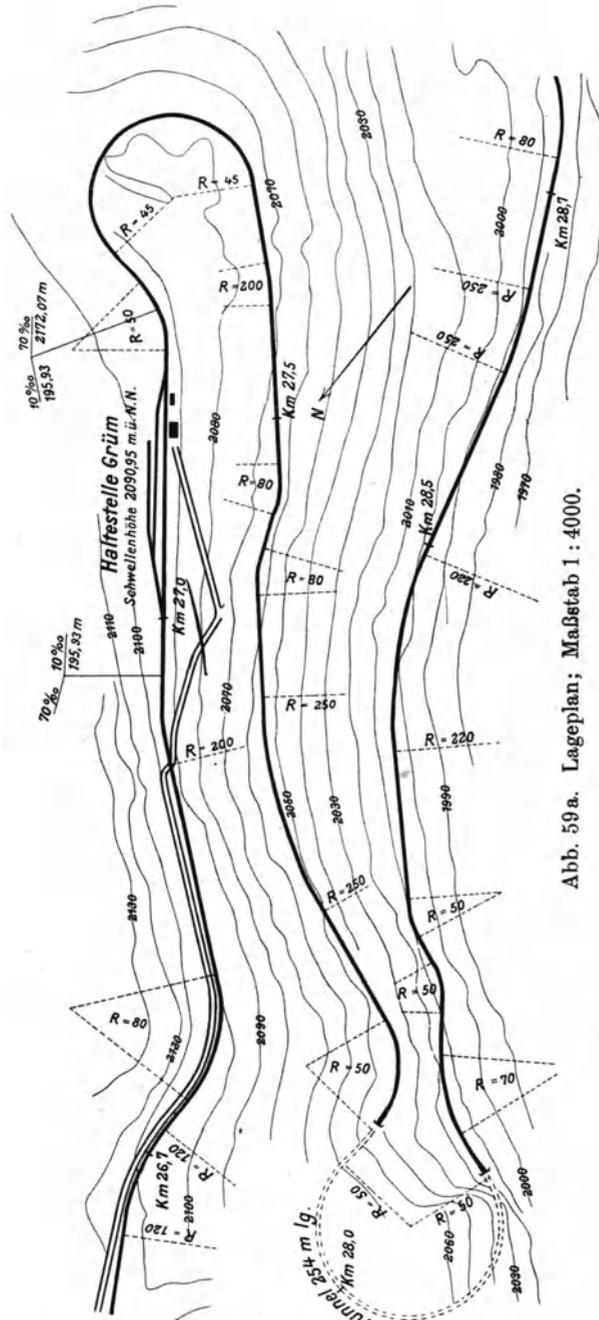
a. Lageplan; Maßstab 1 : 4000.
